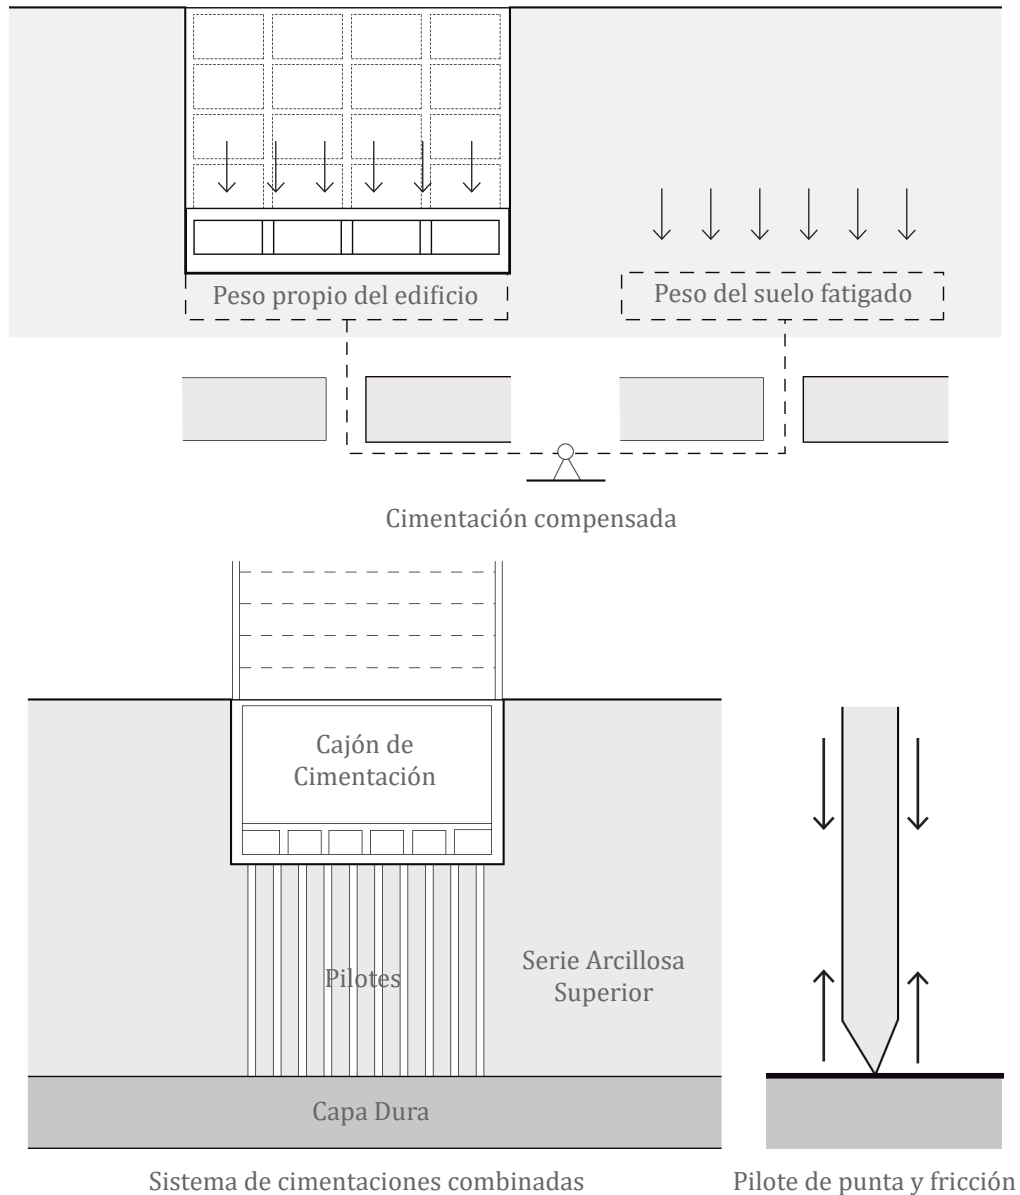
Cimentación del Edificio de la Lotería Nacional. Santoyo Villa. (derecha)
